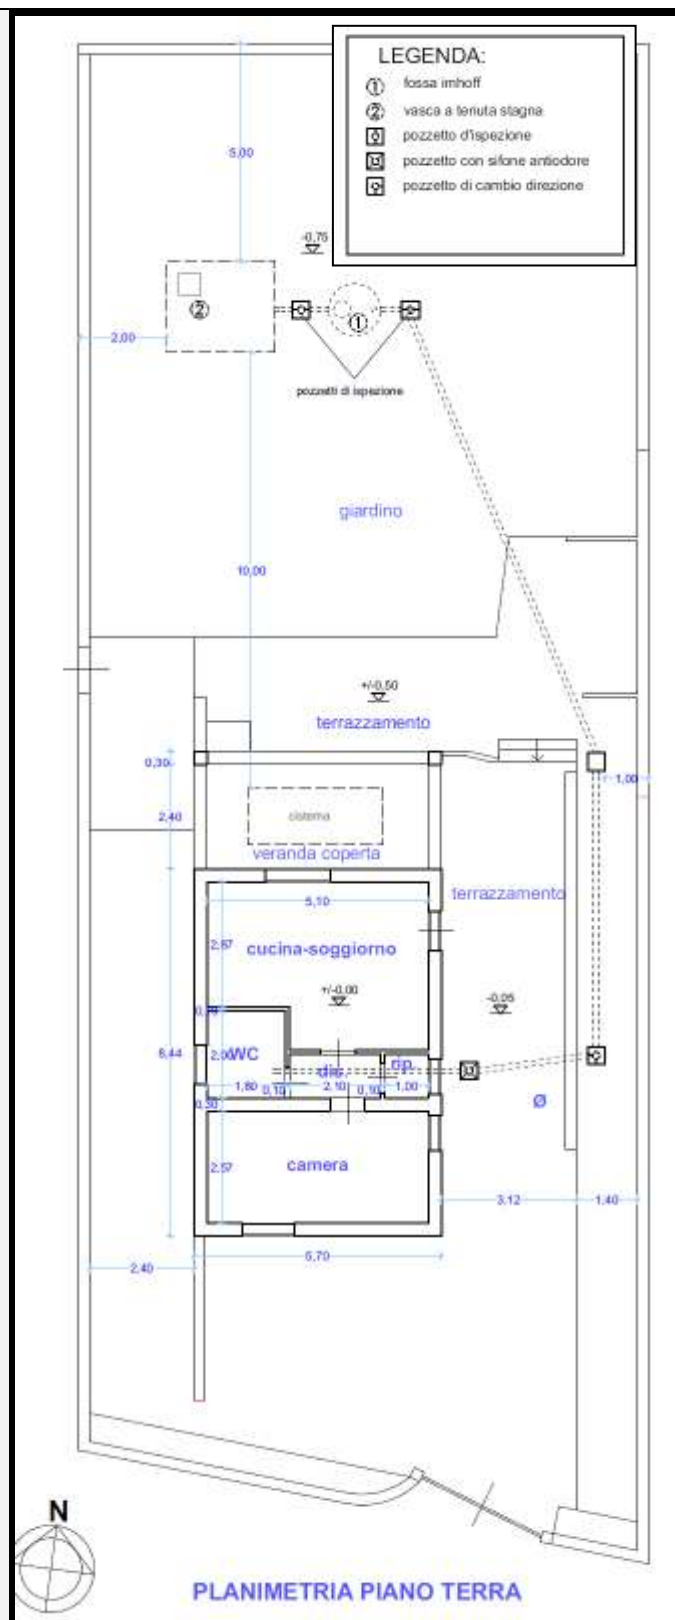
Planimetria generale impianto smaltimento reflui.
